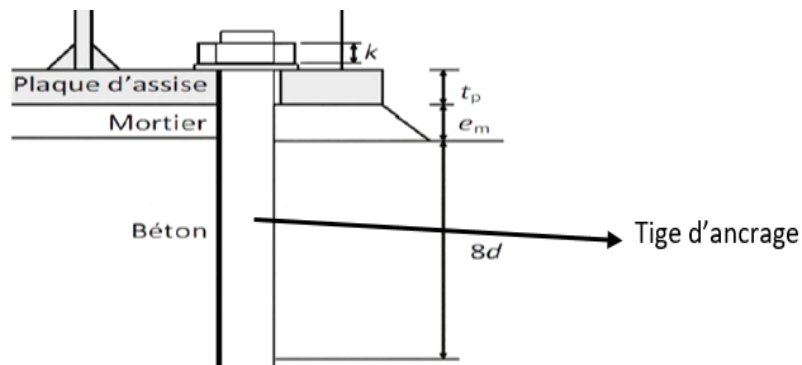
Coupe du pied de poteau et l'ancrage.
